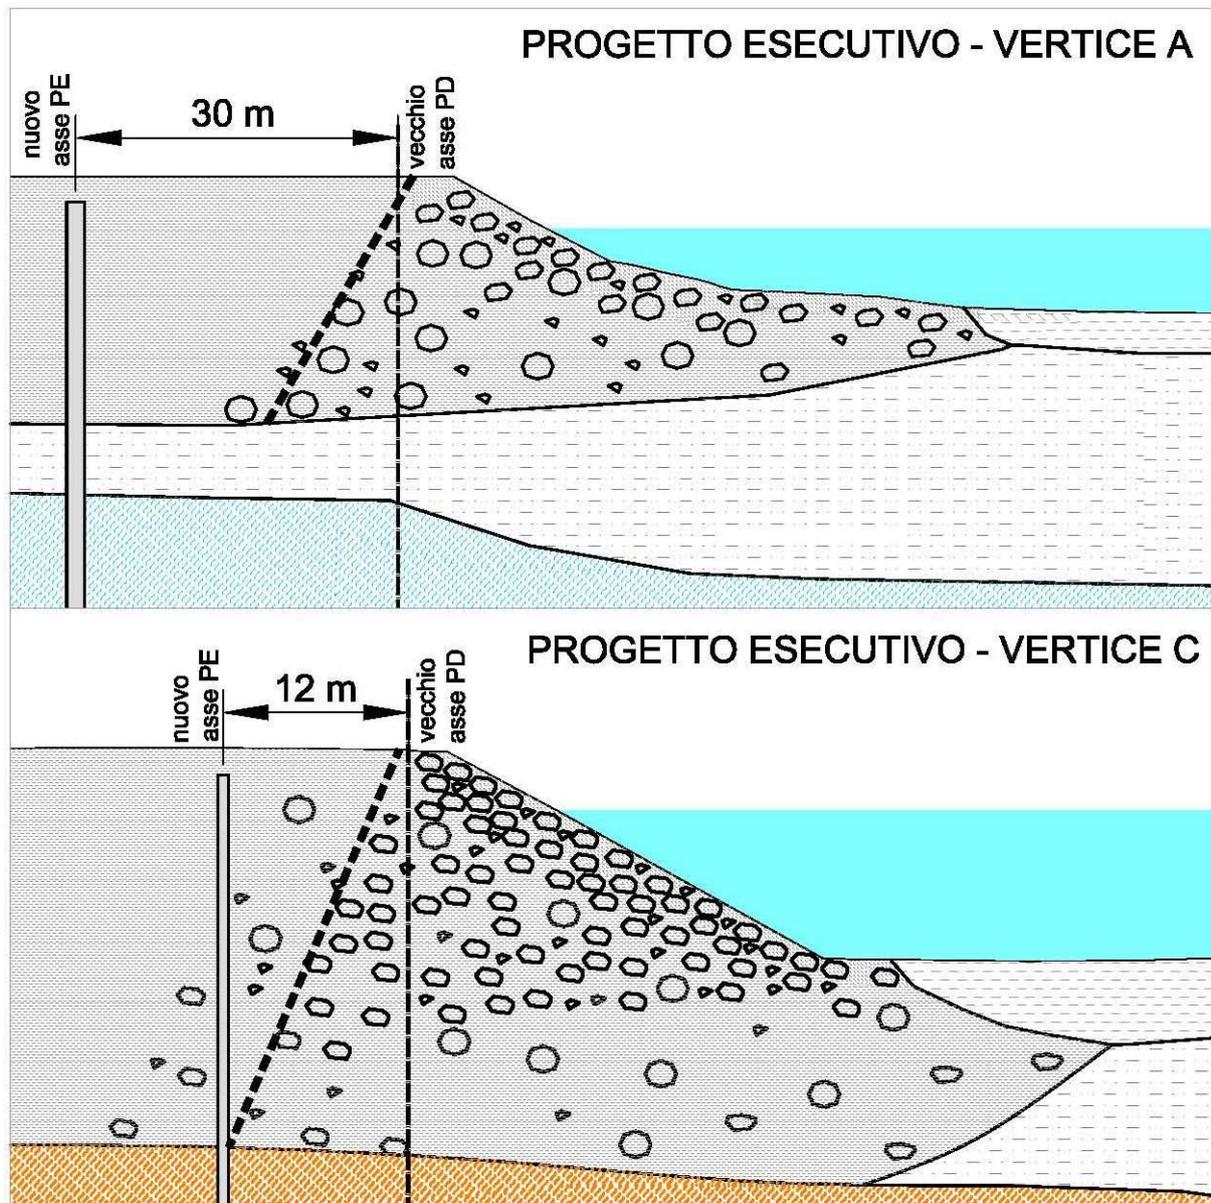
Sezione rilevata dalle indagini del Progetto Esecutivo
